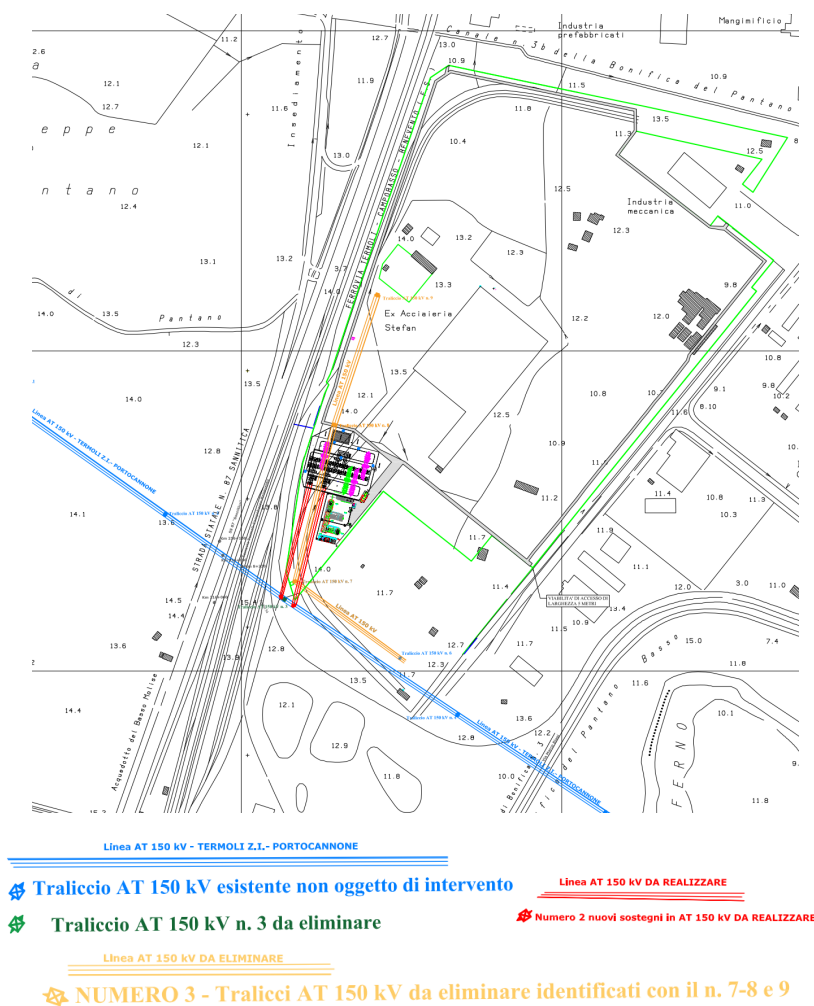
Stralcio delle opere elettriche di riattivazione della Nuova Stazione Elettrica sul sito dell'ex-acciaieria
